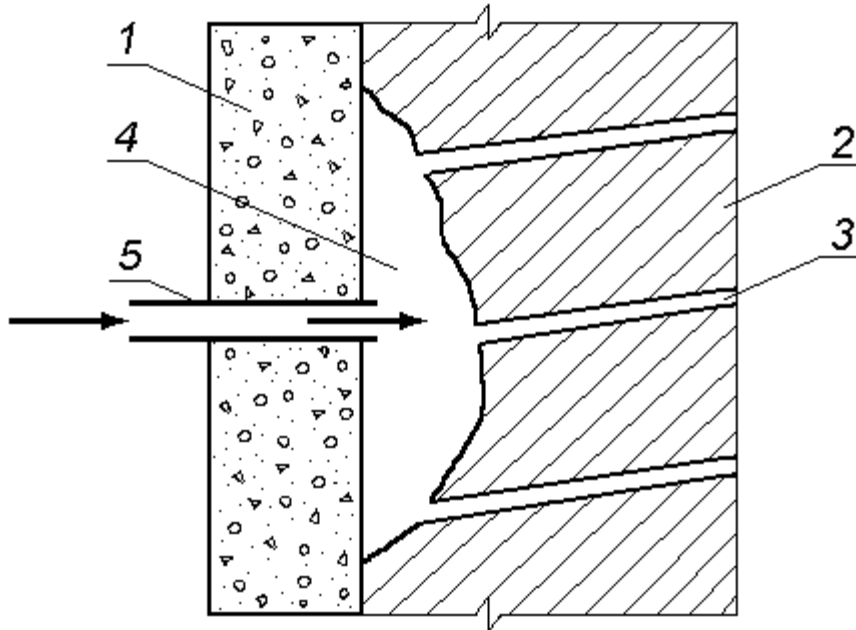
Схема порожнини за обробкою тунелю: 1 – обробка; 2 – скельний ґрунт; 3 – тріщини; 4 – порожнина; 5 – ін'єктор
